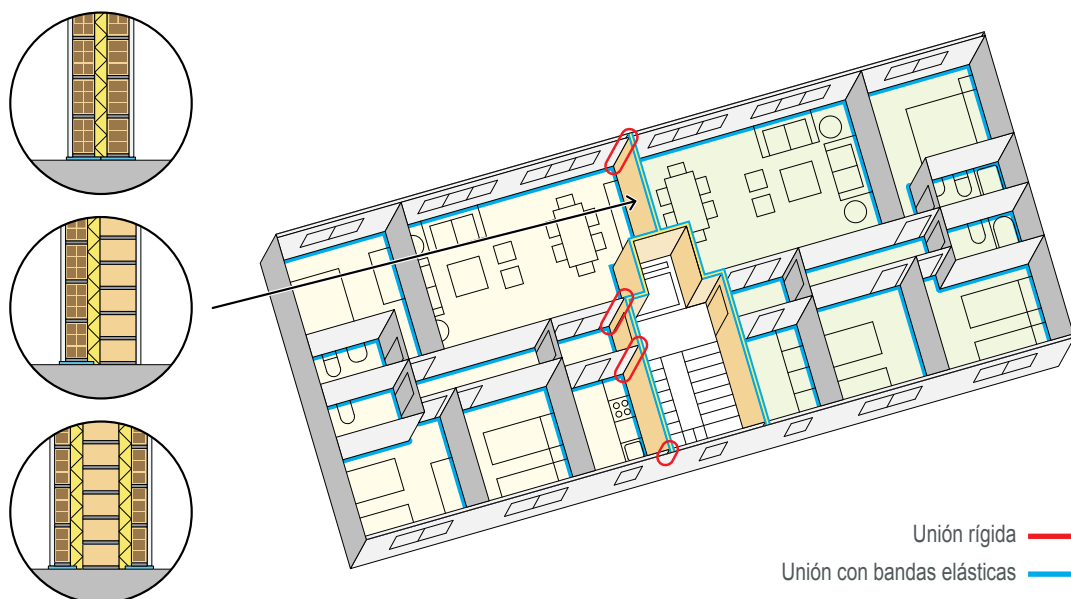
CASO 1: separadora entre viviendas de DOS o TRES hojas y edificio CON exigencia de aislamiento acústico en vertical. Colocación de bandas elásticas en los tabiques y hojas interiores de la fachada.
